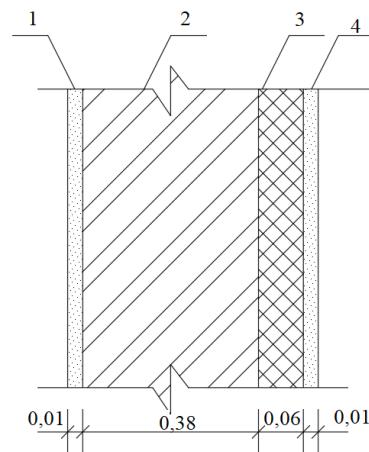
Наружная ограждающая стена с теплоизоляционного слоя. 1 - штукатурка, 2 - кирпичная кладка, 3 - теплоизоляционный материал, 4 – штукатурка.
